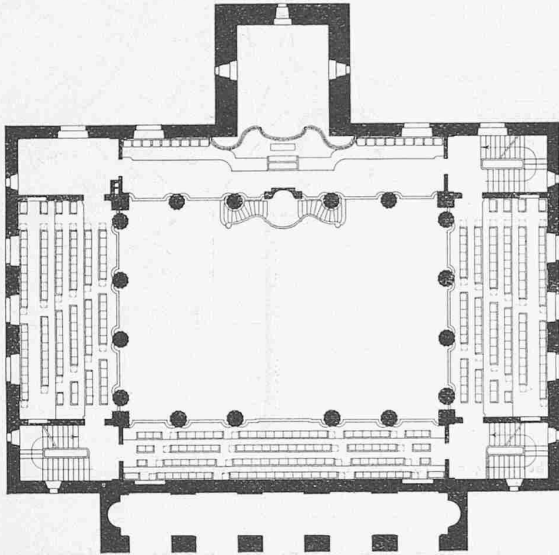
Grundriss vom Galerie-Geschoss. — 1 : 400.
